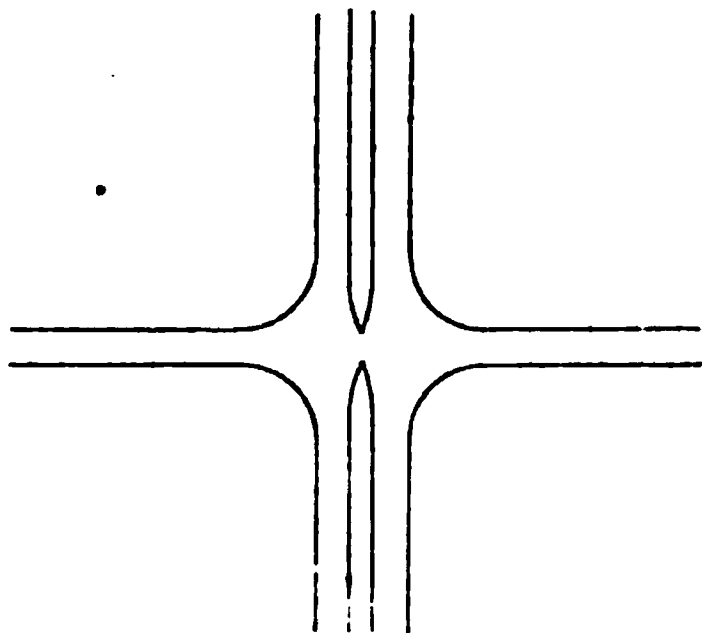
Raccordement d'un plan incliné et d'un chassage.
